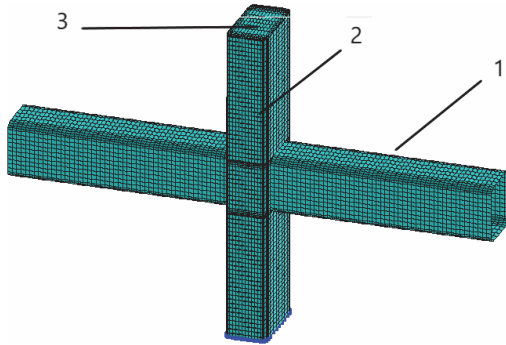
Общий вид ТБ узла в ПК «Лира САПР»: 1) ригель из КЭ пластин; 2) стойка из КЭ пластин; 3) бетонное ядро из объемных КЭ.
